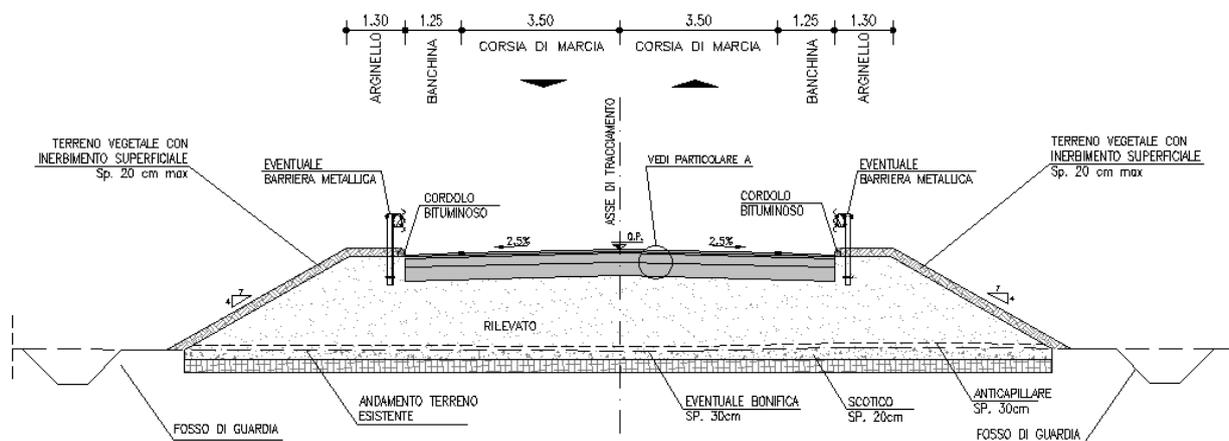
Sezione tipo di progetto assi SP204 nord e sud
